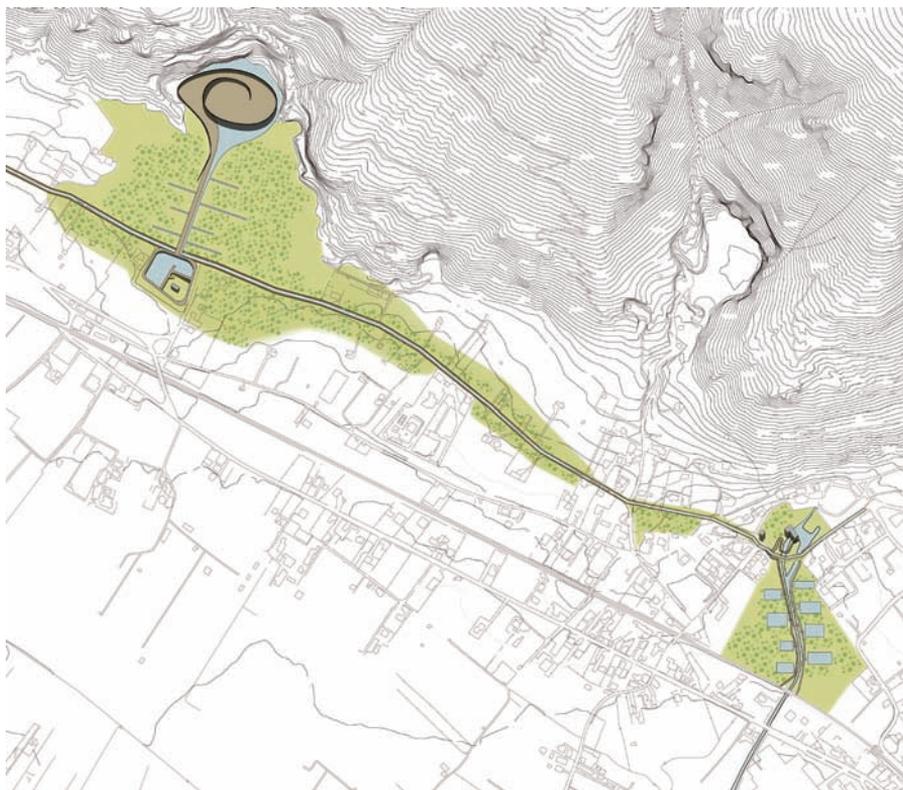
Planimetria d'insieme delle due aree di progetto
